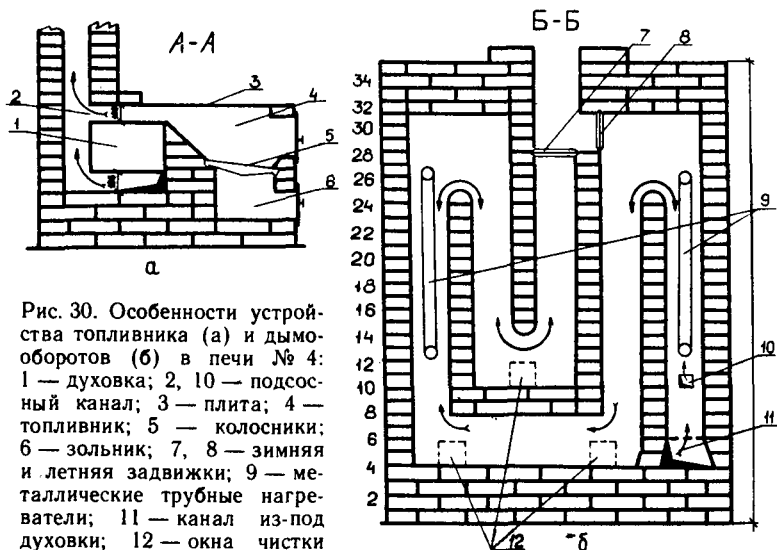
Особенности устройства топливника (а) и дымооборотов (б) в печи № 4: 1 — духовка; 2, 10 — подсосный канал; 3 — плита; 4 — топливник; 5 — колосники; 6 — зольник; 7, 8 — зимняя и летняя задвижки; 9 — металлические трубные нагреватели; 11 — канал из-под духовки; 12 — окна чистки
